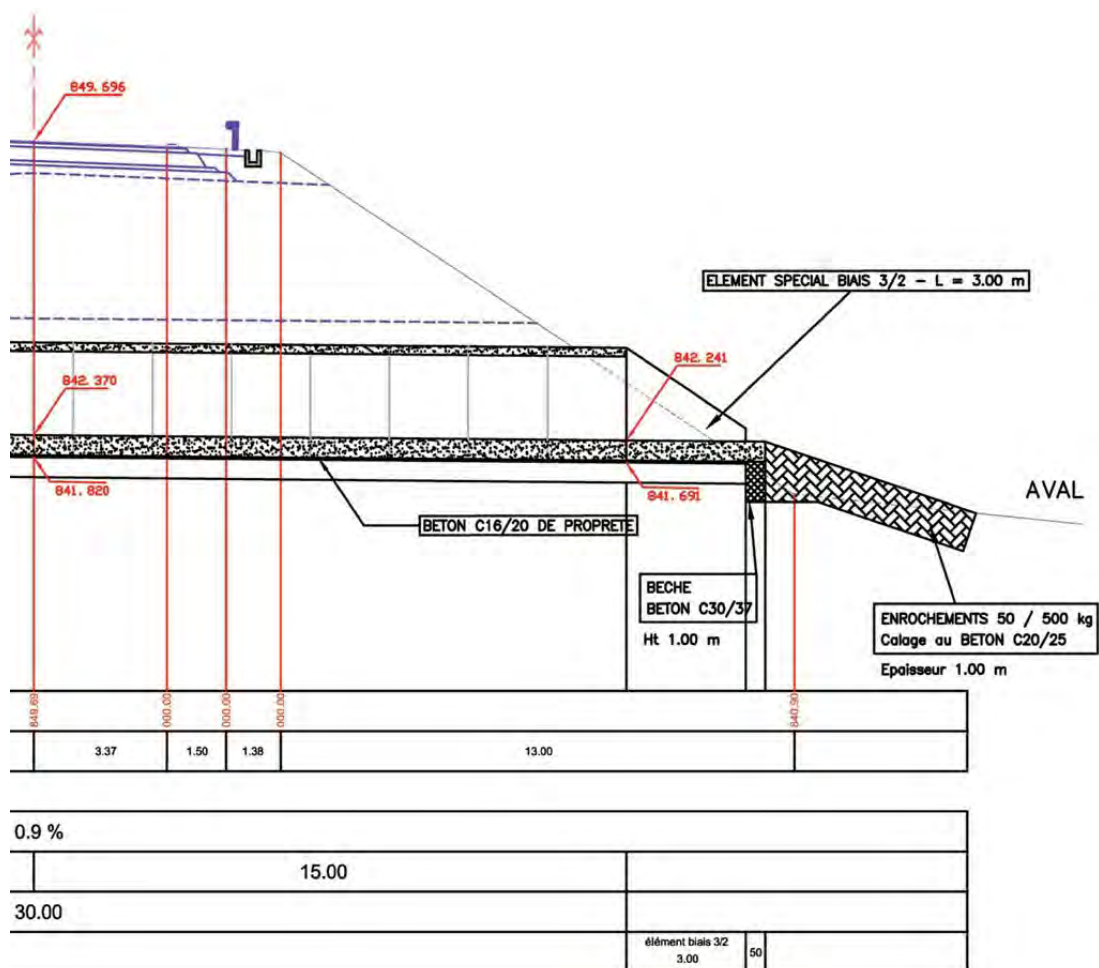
Coupe longitudinale d'un ouvrage de rétablissement. (Voir p.16-17)
